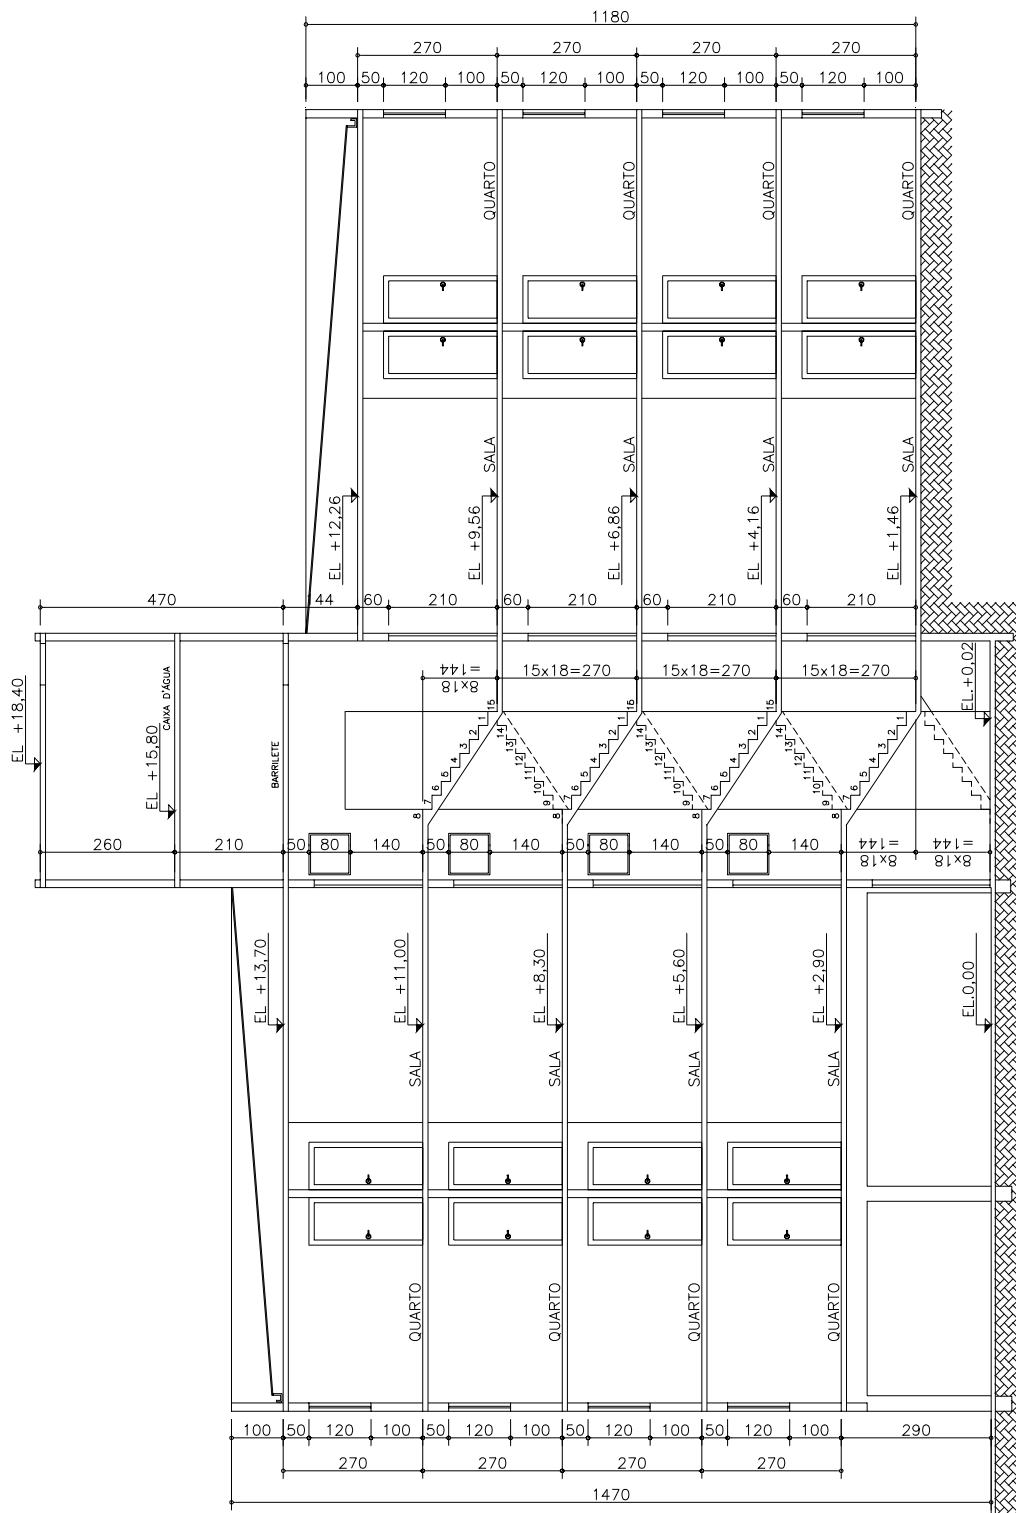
Prédio “C” – Corte esquemático longitudinal A-A
